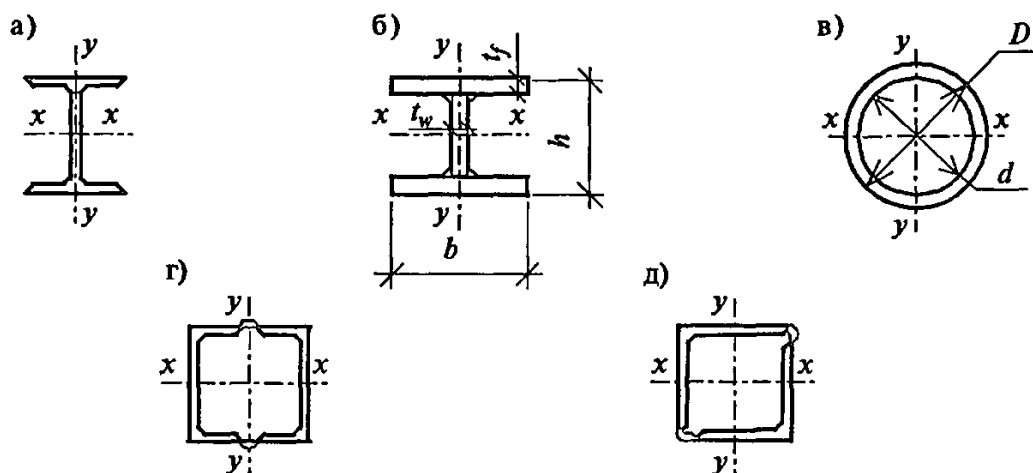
Сечения сплошных колонн: а) прокатный двутавр; б) сварной двутавр; в) труба; г) сечение из двух швеллеров; д) сечение из двух уголков
